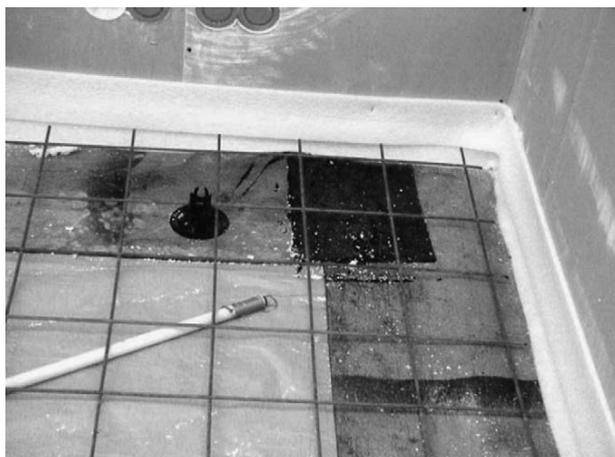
Feltro de betume instalado na junta da parede de fundação e laje de pavimento antes da colocação do pavimento (Arvela et al., 2005).
